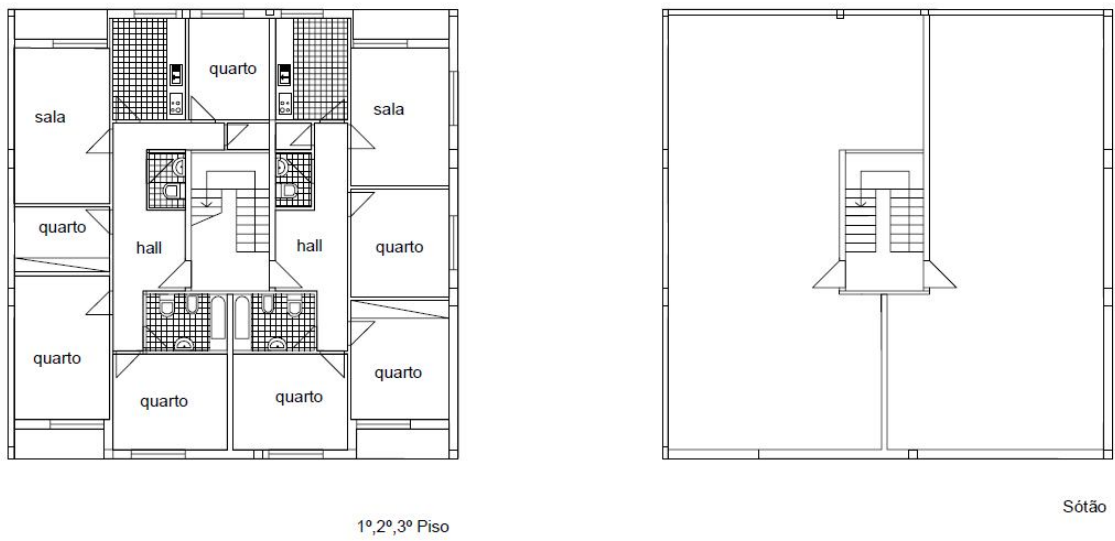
Planta dos pisos 1,2, 3 e da laje de esteira do edifício localizado em S. Victor
